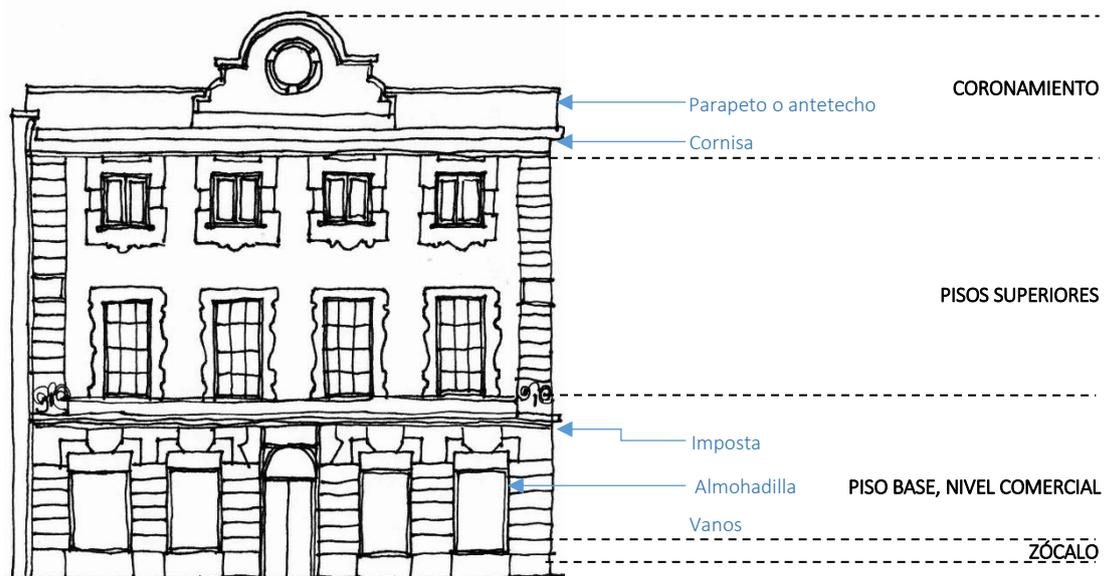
Fachada del edificio Huth y Cía., ejemplo de reconocimiento de los elementos de fachada.
